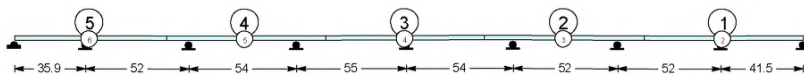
Схема последовательности бетонирования (большими кружками обозначены участки бетонирования плиты проезжей части, мелкими кружками – участки пролетного строения, где снимается опалубка, цифра в кружке означает номер этапа бетонирования)
